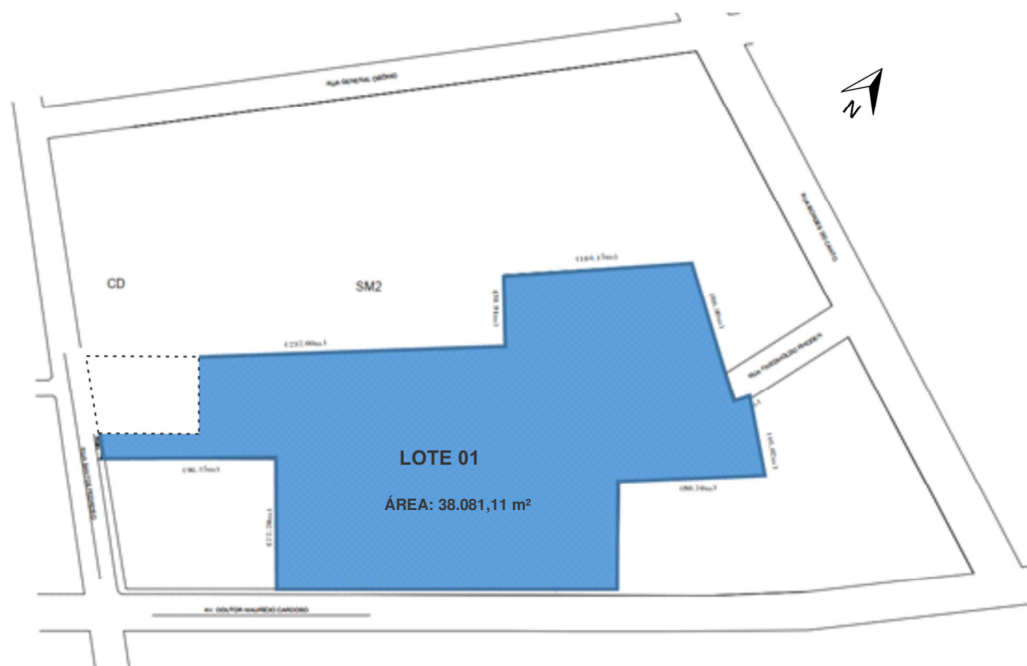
Planta de Situação do Lote 01 após o desmembramento. Fonte Acervo do empreendedor.
